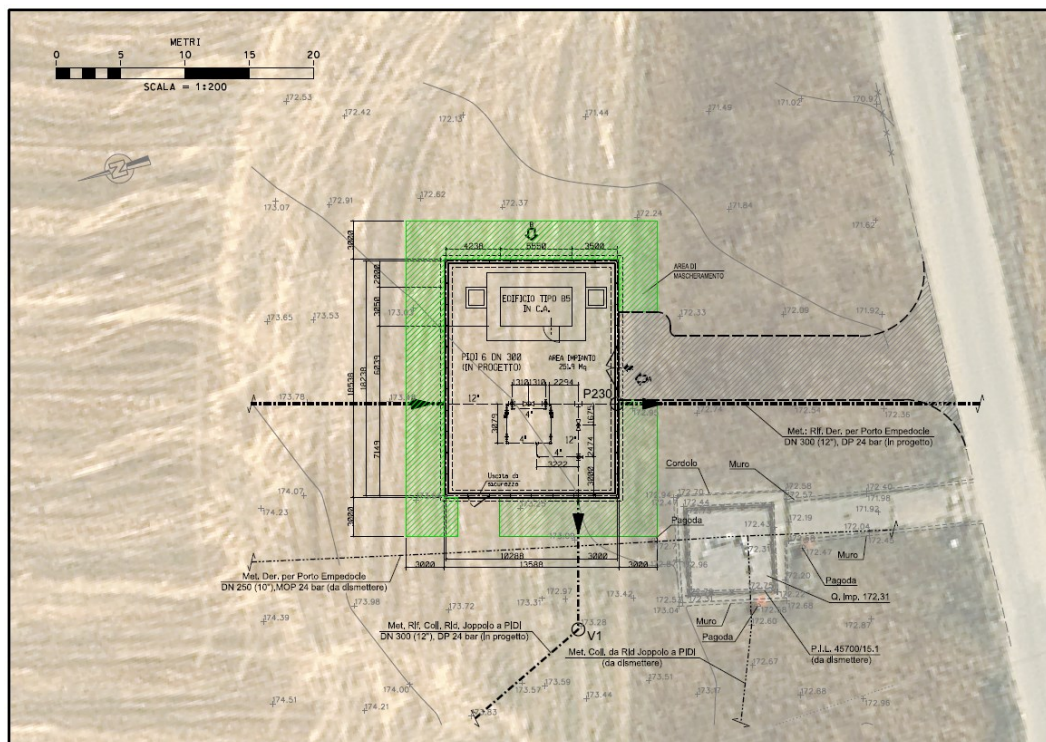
Stralcio planimetrico con ortofoto - riproduzione non in scala
